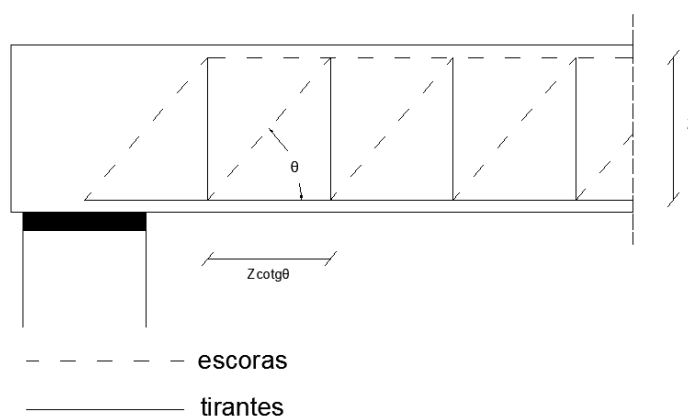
Modelo de treliça aplicado a uma viga de betão armado.
